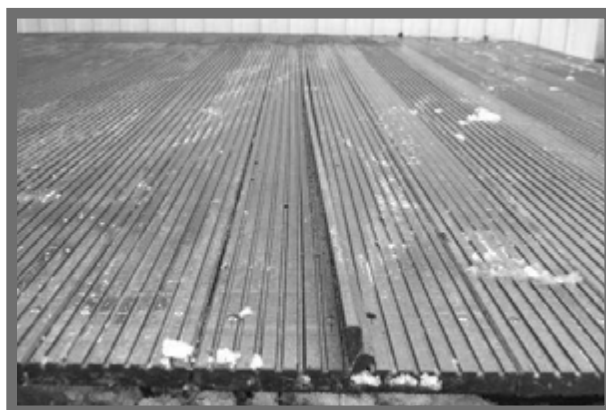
Bei der Montage wurde die Holzfeuchte nicht geprüft und die Holzdielen mit zu geringem Fugenabstand montiert. Im Winter ist das Holz aufgequollen und stellt sich dann auf.
